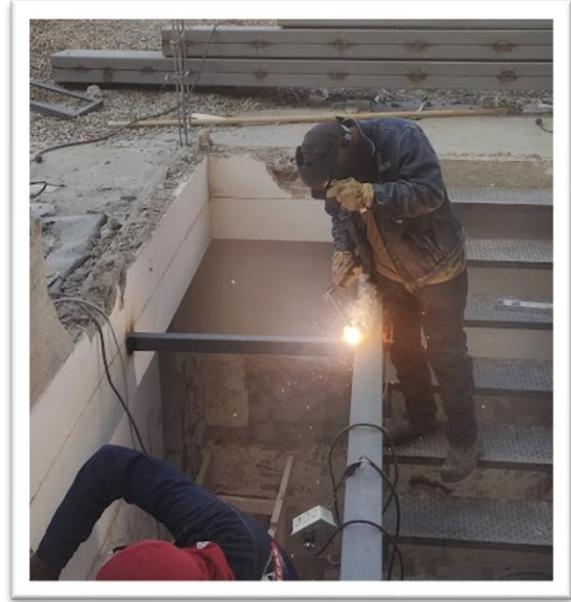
soldadura de vigas para instalación de metaldeck
